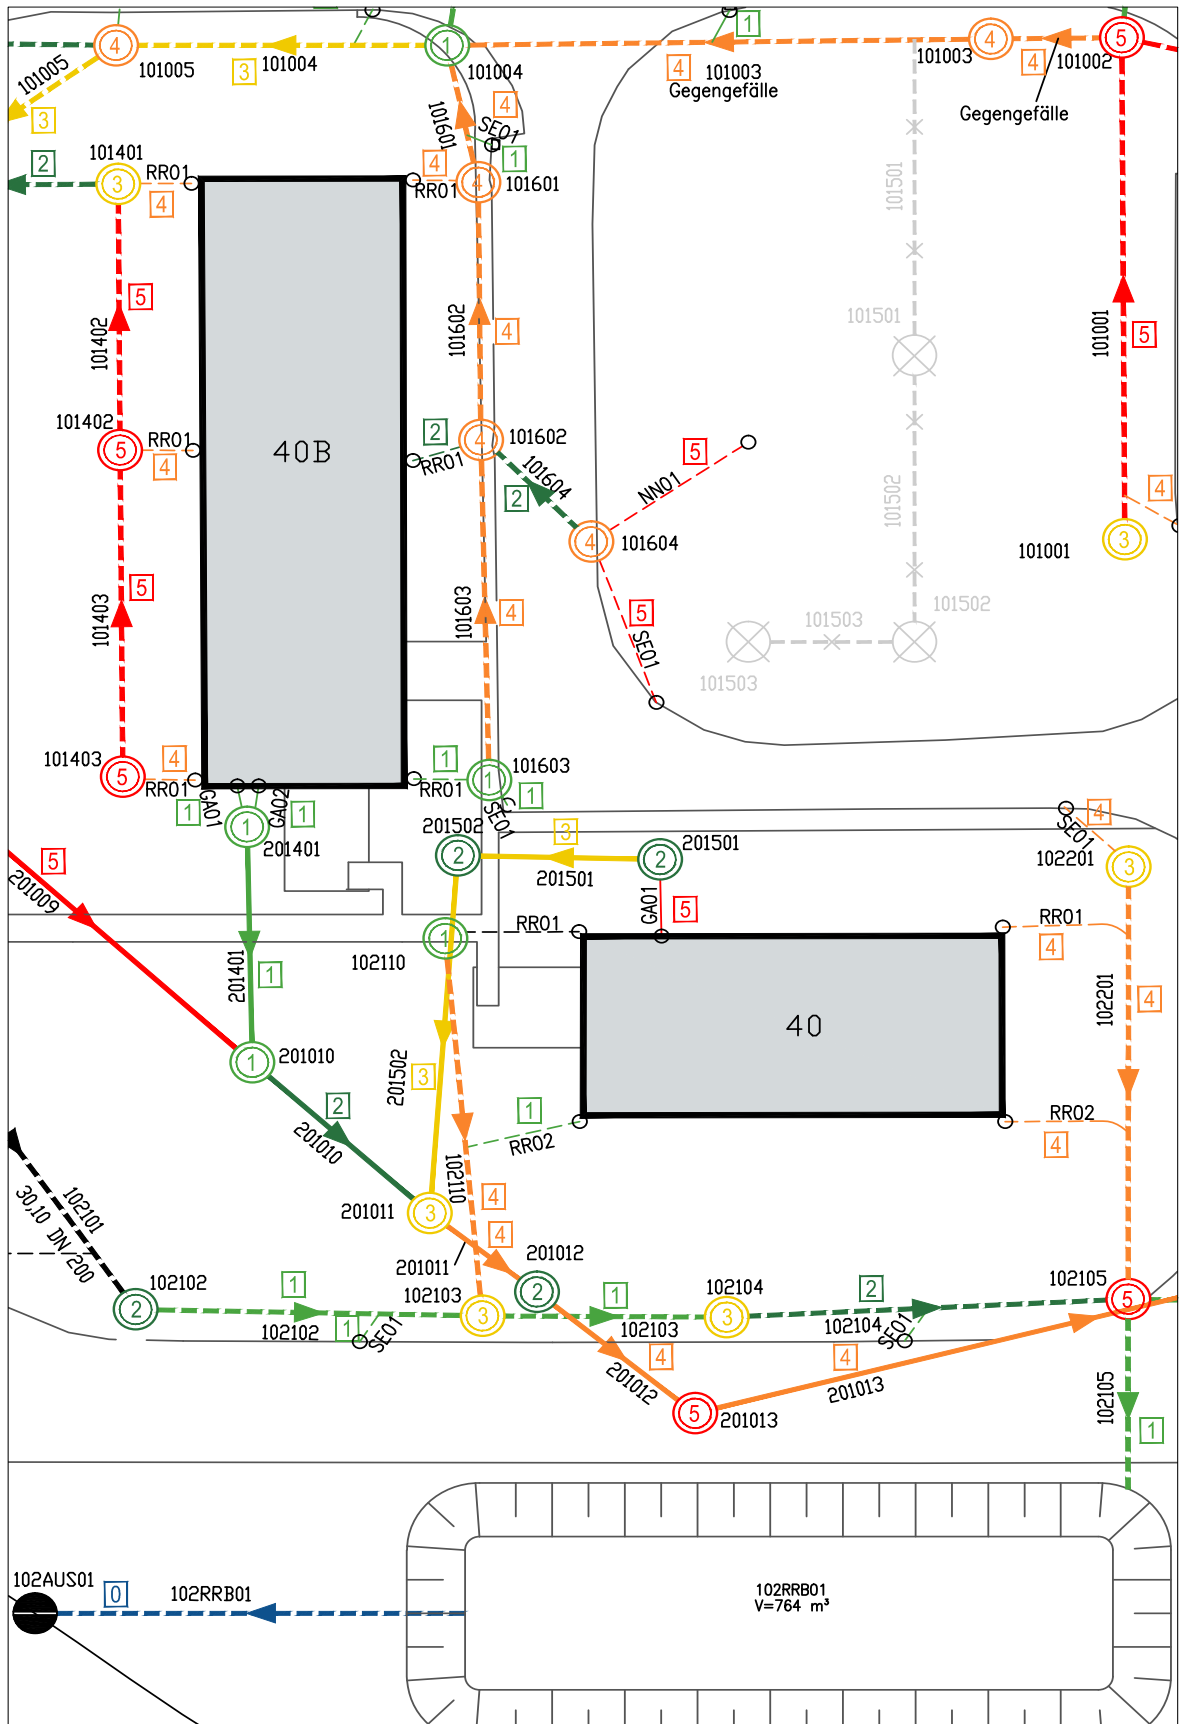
9 Beispielplan: Lageplan „Bautechnische Zustandsbewertung“
